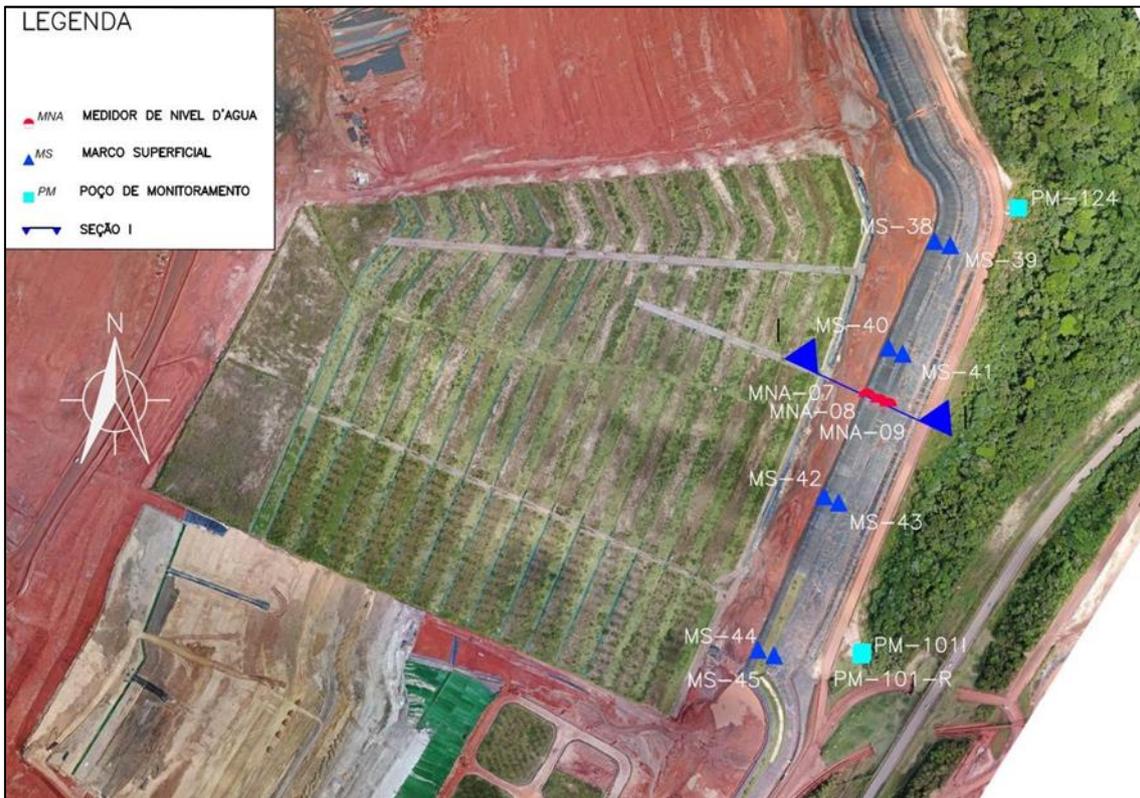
Localização em planta da instrumentação instalada na Seção I (PIMENTA DE AVILA, 2022)
